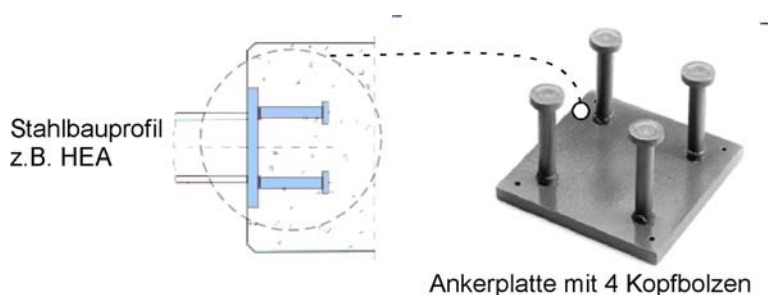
Einsatz von Ankerstäben auf einer Ankerplatte zum Anschluss eines Stahlbauprofils an ein Betonbauteil
